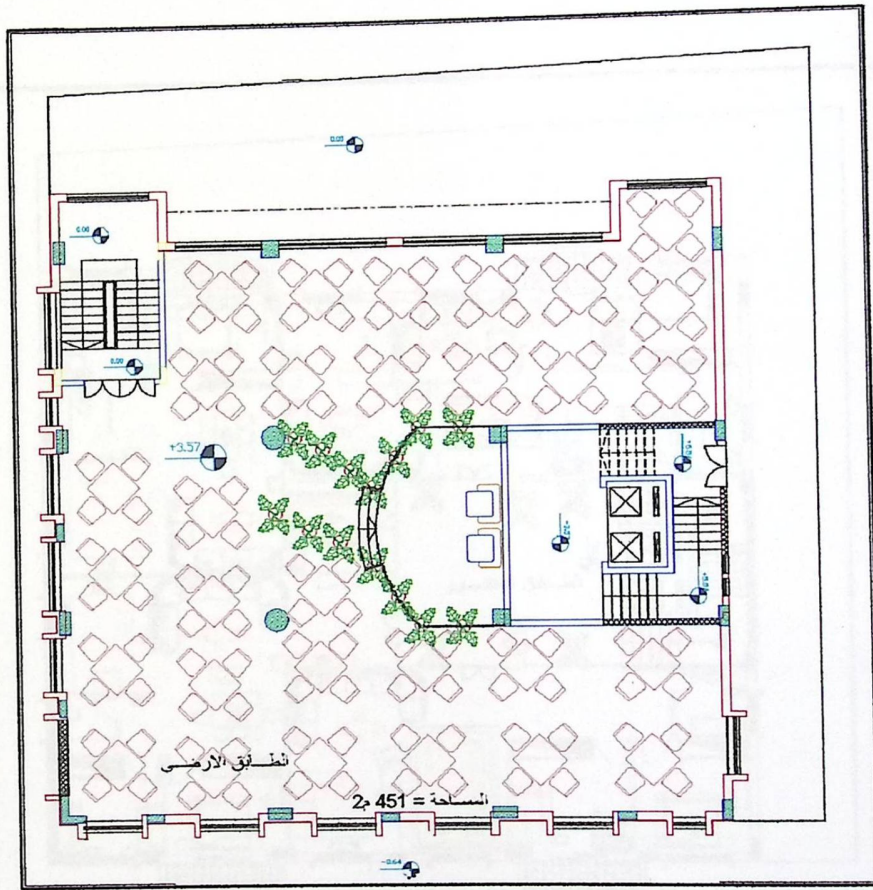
المسقط الأفقي للطابق الأرضي
